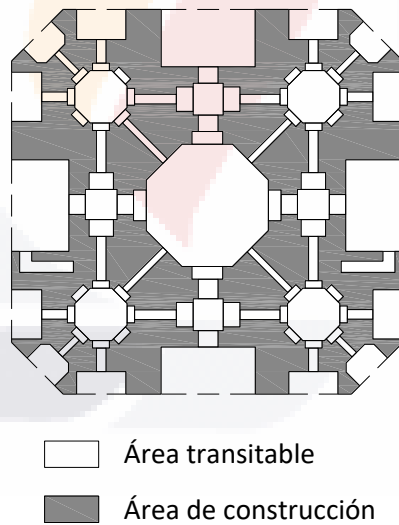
Planta constructiva del mausoleo Taj Mahal
